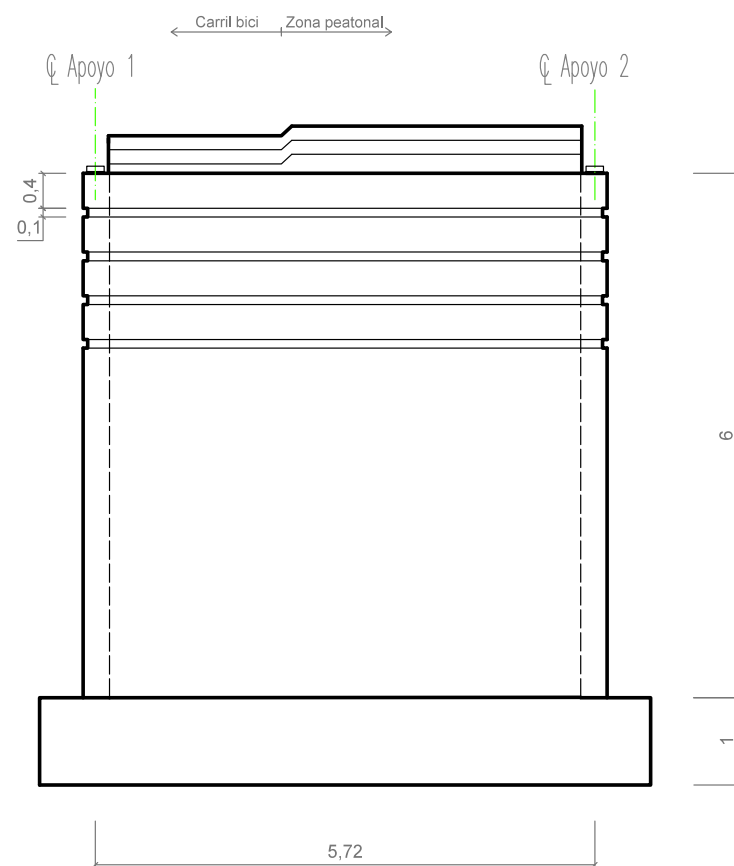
b. Alzado de la cimentación (Escala 1:50).
